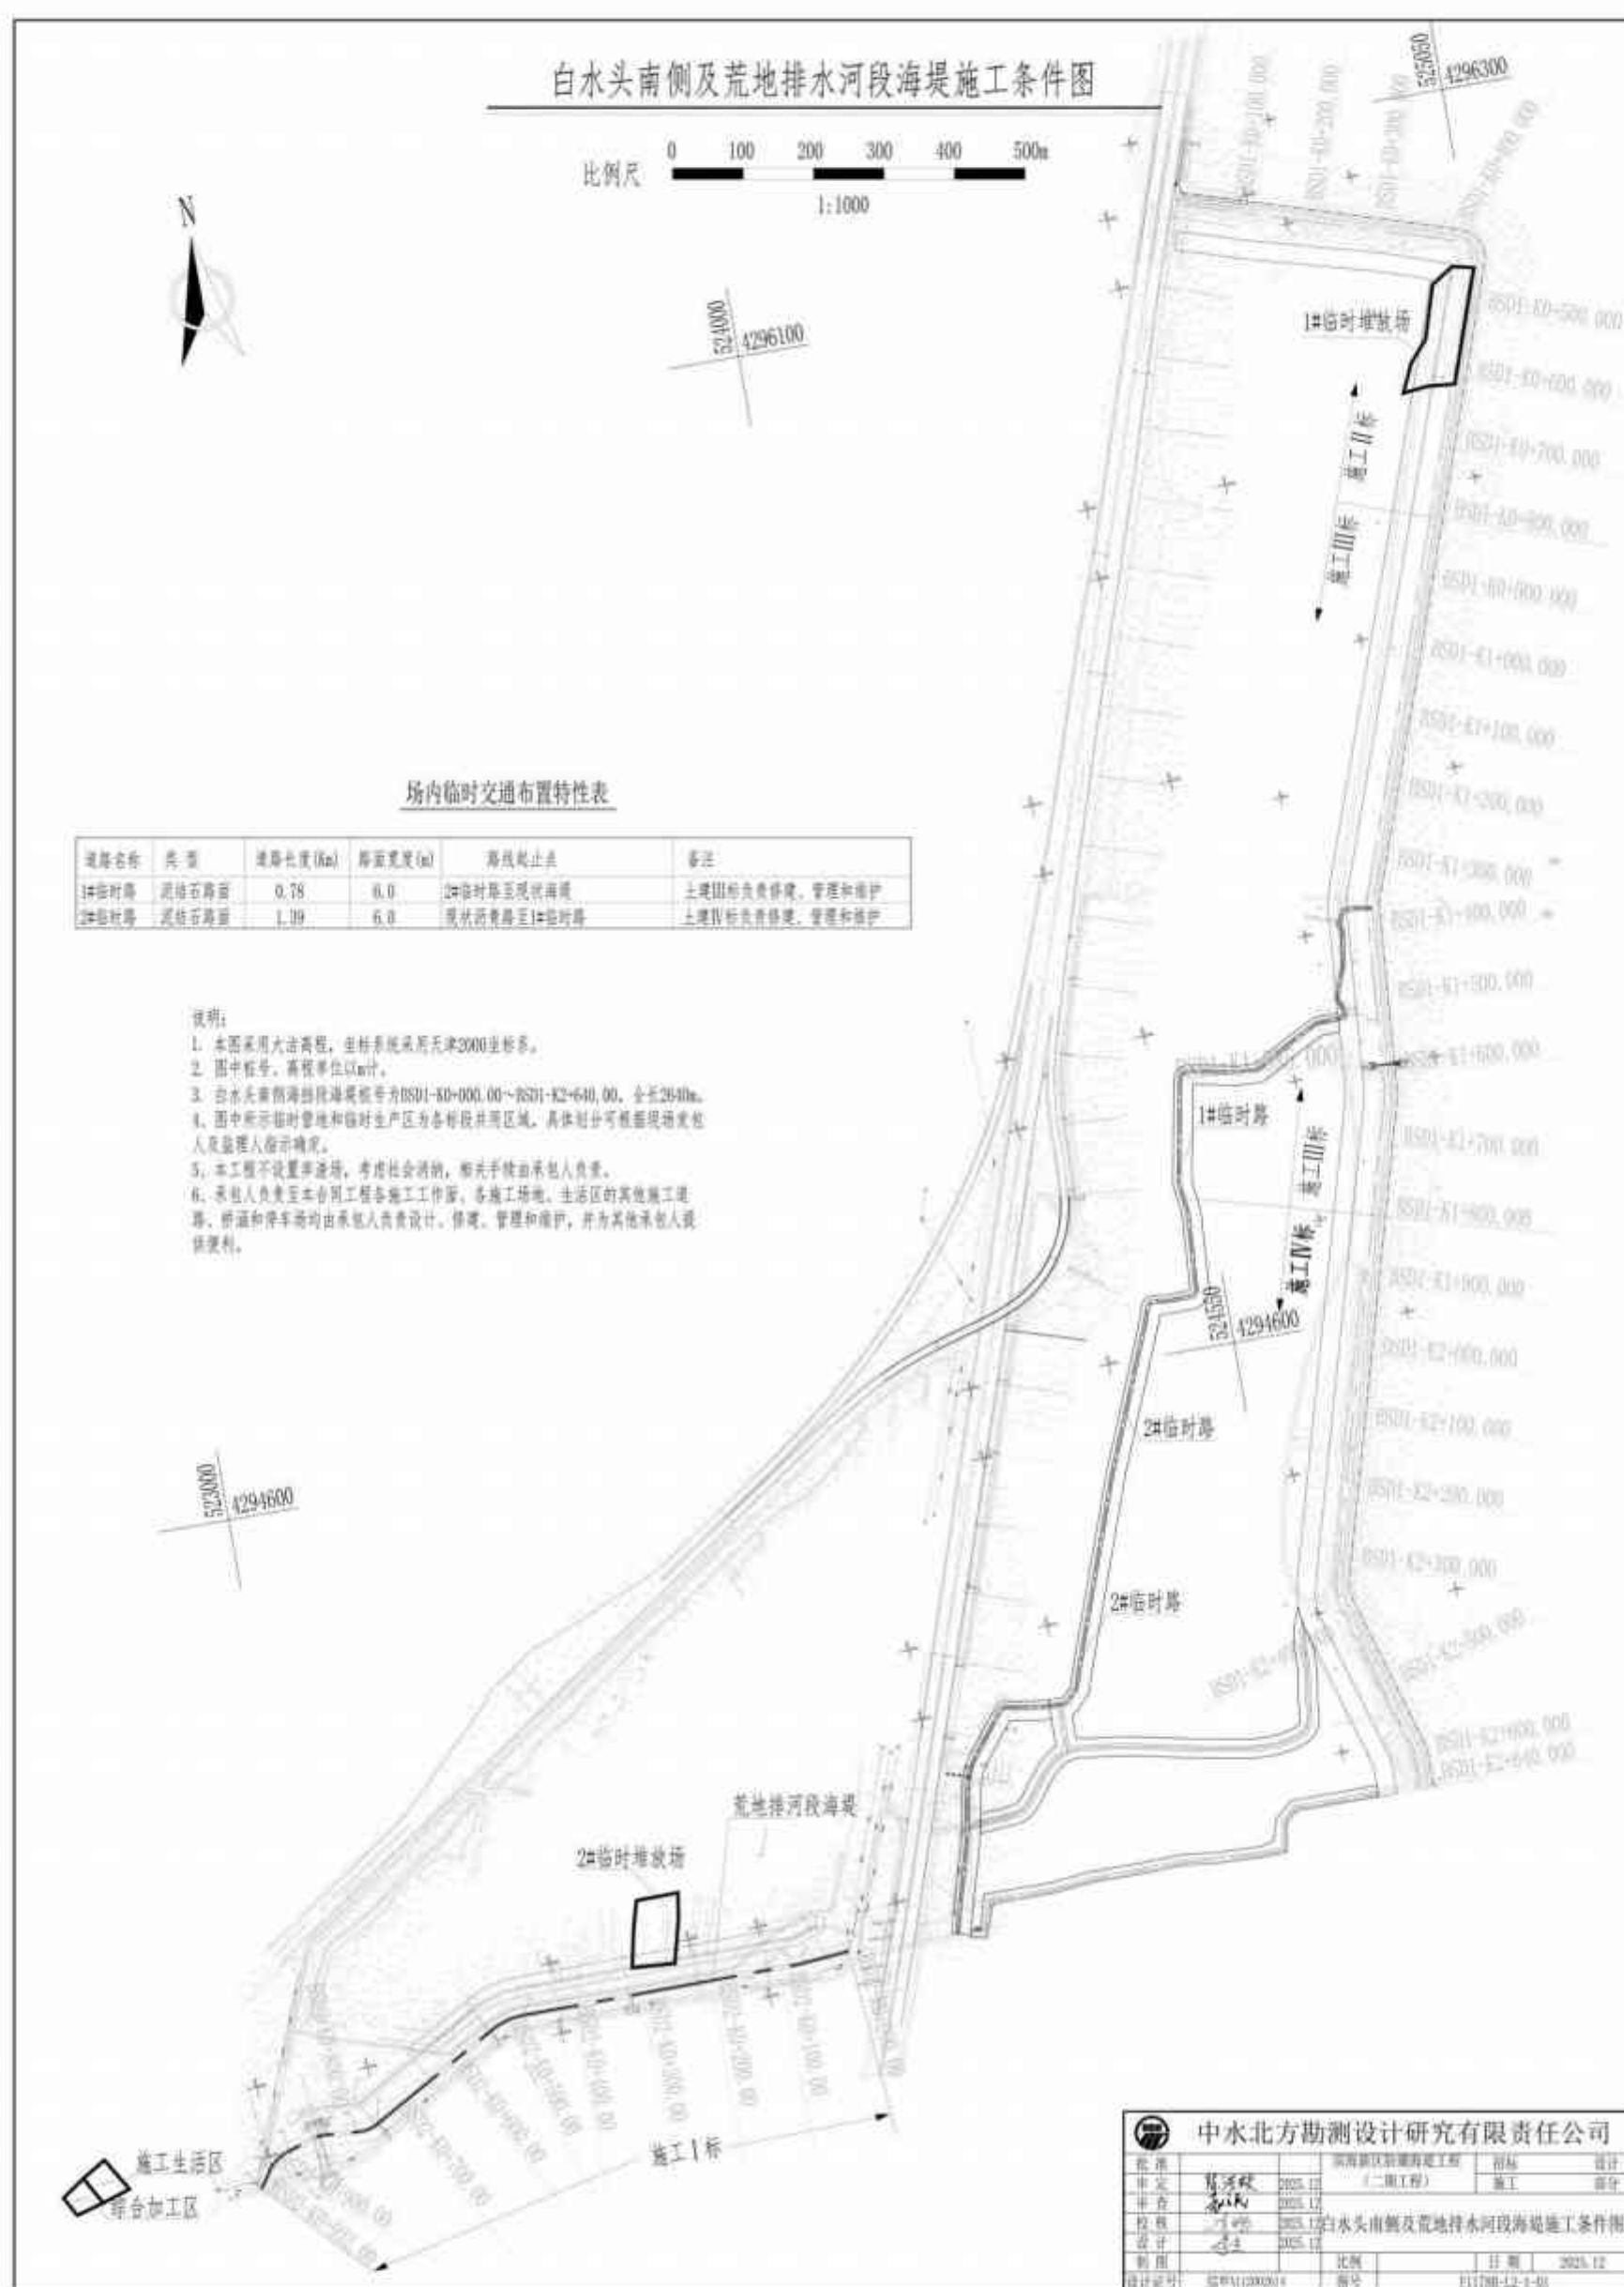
白水头南侧海挡段和荒地排水河段海堤施工总平面布置图
